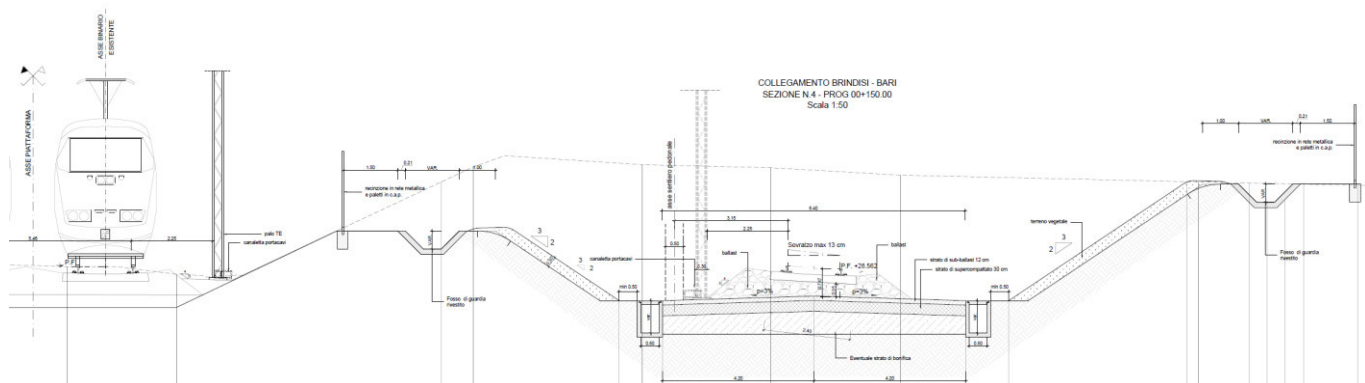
Sezione tipo stretto affiancamento Raccordo Bari
